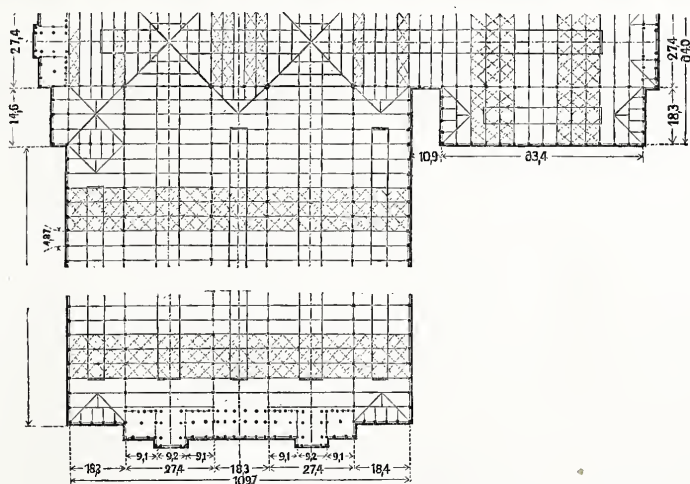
Grundriss eines Theils der Maschinenhalle.
